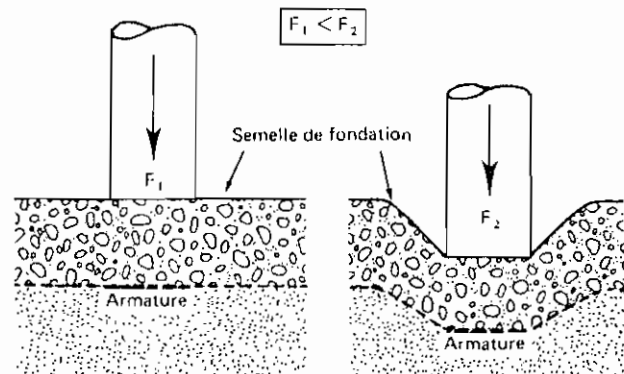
Schéma de déformation d'une semelle de fondation.
